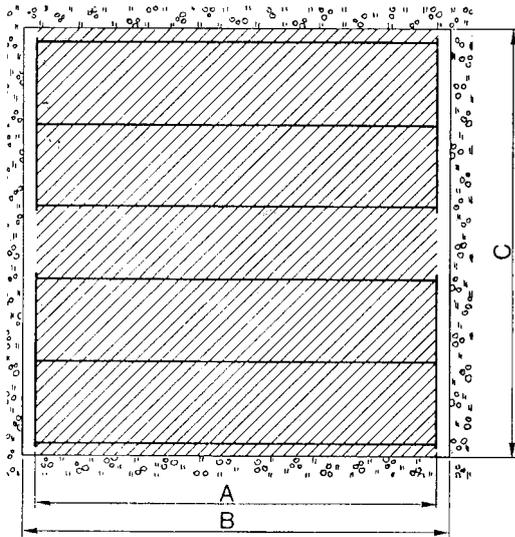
Beheizte Decke mit Rohrabständen von 600 mm
